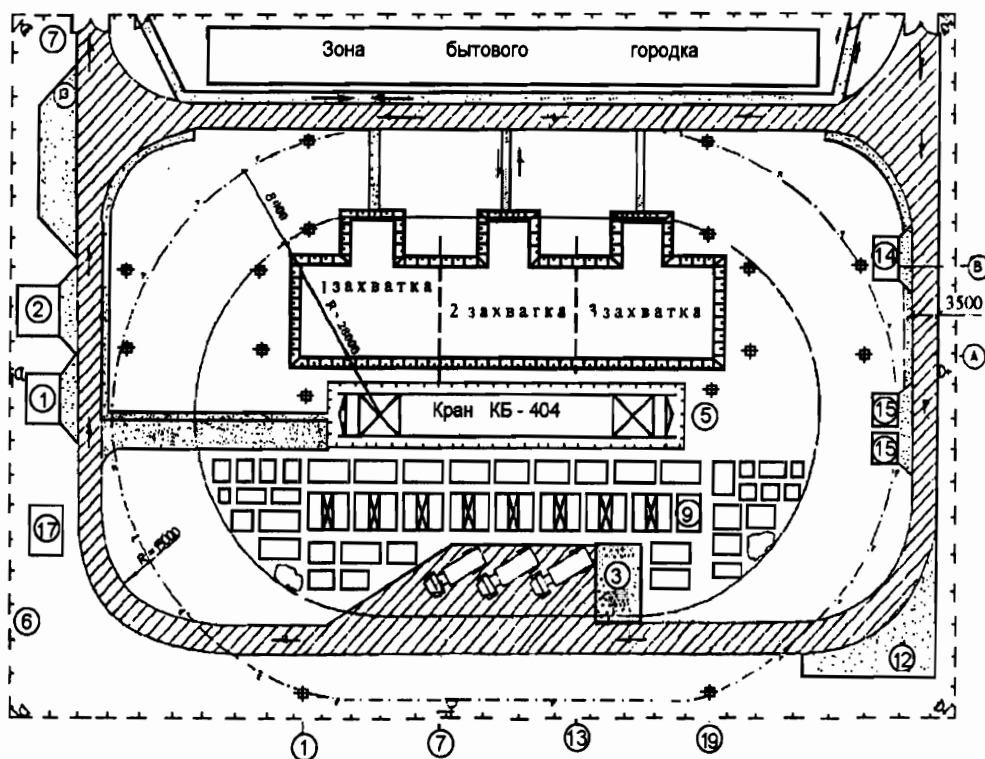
Строительный генеральный план на возведение подземной части здания
